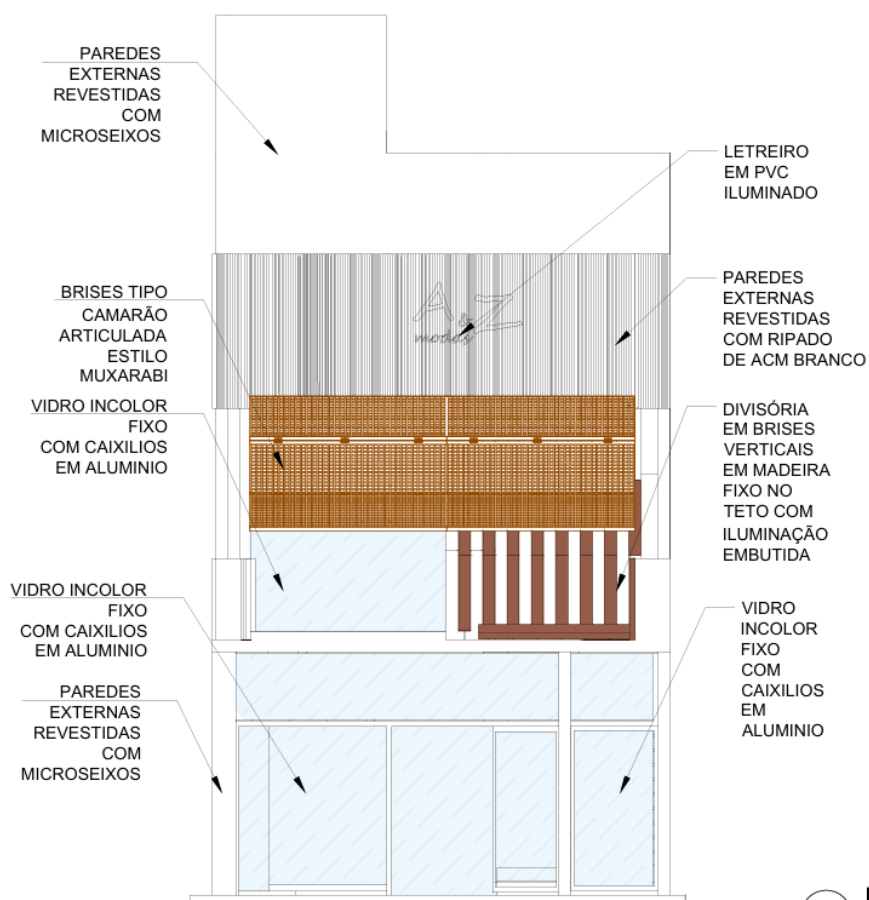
Cortes, fachada e renderizações - Proposta de Reforma
